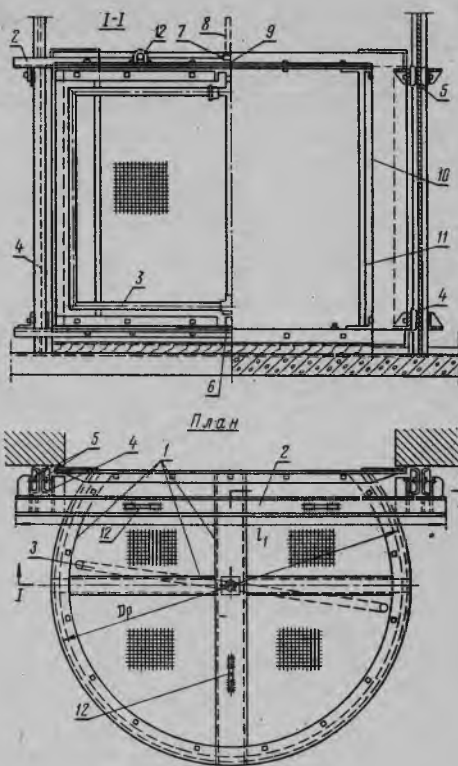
Схема самоочищающегося сетчатого рыбозаградителя на железобетонных и ряжевых оголовках для расходов от 0,15 до 3,6 м³/сек при водозаборе из рек и водохранилищ:
